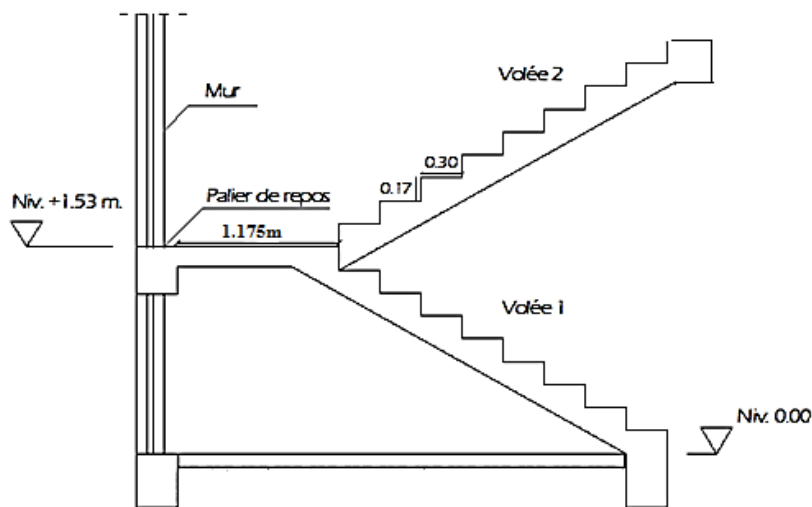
2: Coupe verticale de l'escalier de la structure.
